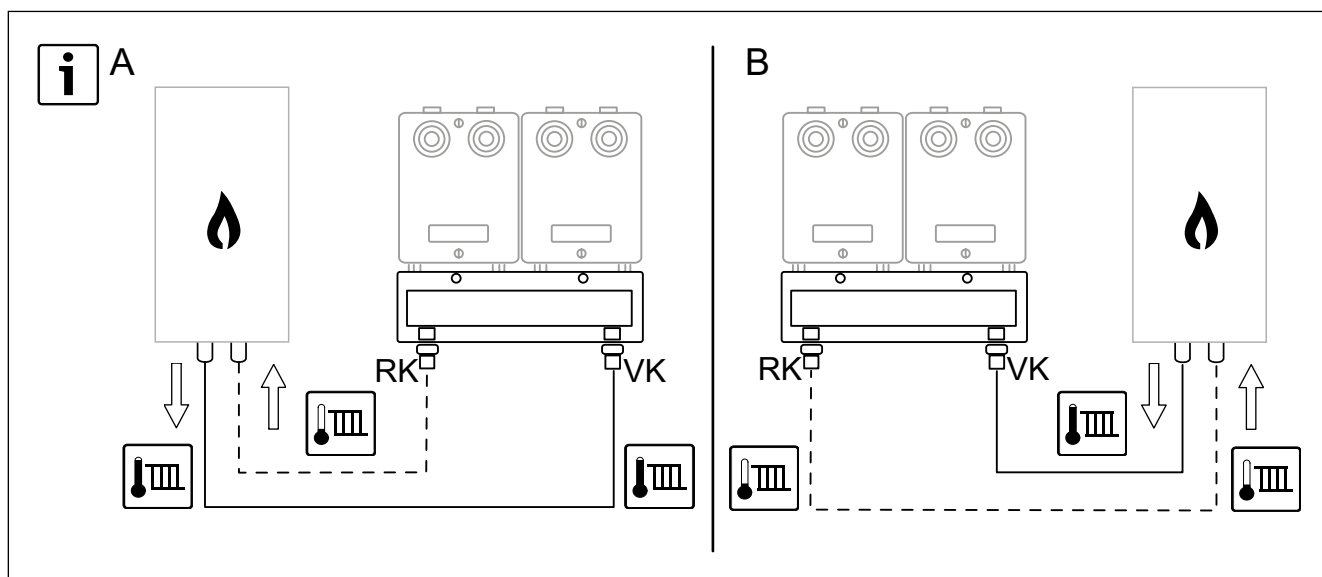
Termohydraulický oddělovač WHY 80x120, DN32 (do cca 116 kW)
